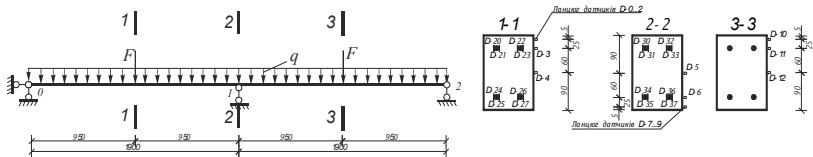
Розрахункова схема та схема розташування електротензодатчиків на бетоні та арматурних стержнях балок
